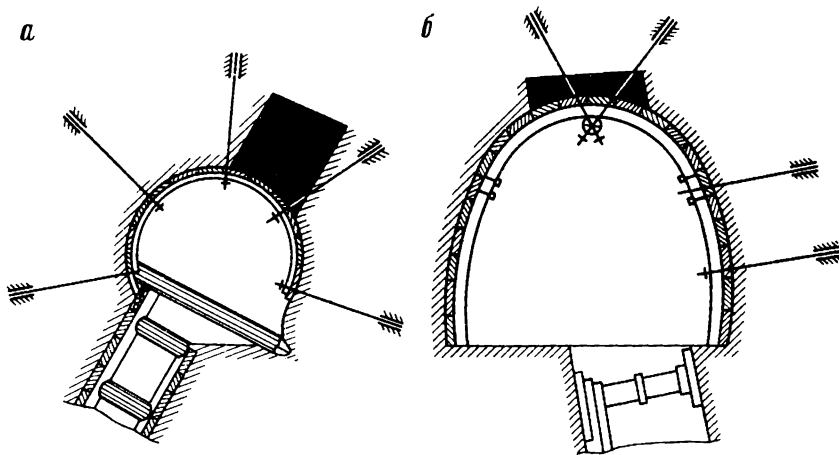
Варианты крепления верхних сопряжений лав при отработке пластов крутого падения
